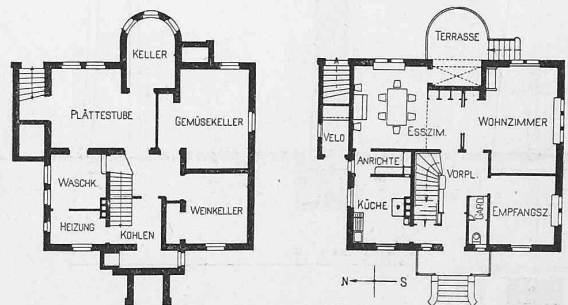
und 4. Grundrisse vom Kellergeschoss und Erdgeschoss. Masstab 1 : 400.
